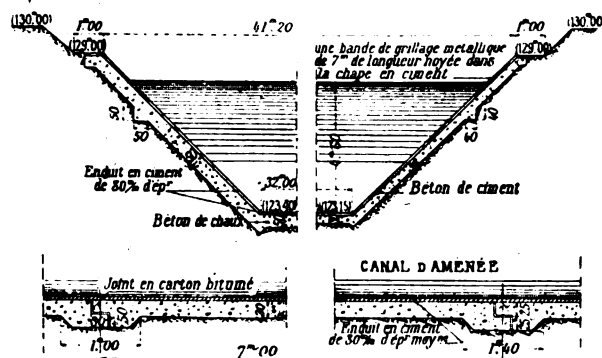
et 10. — Coupes partielles des parois et du plafond du canal d'aménée.
